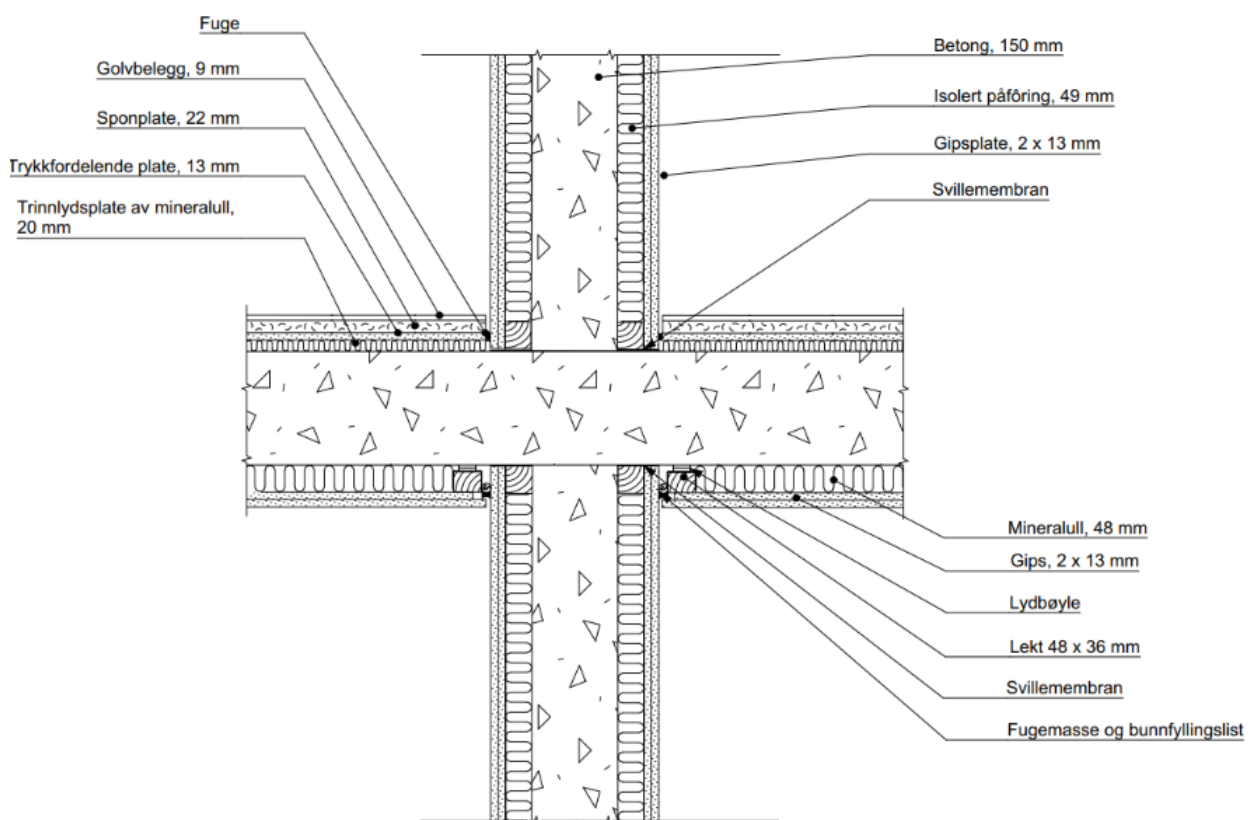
Overgang vegg mellom leilighet/etasjeskiller
